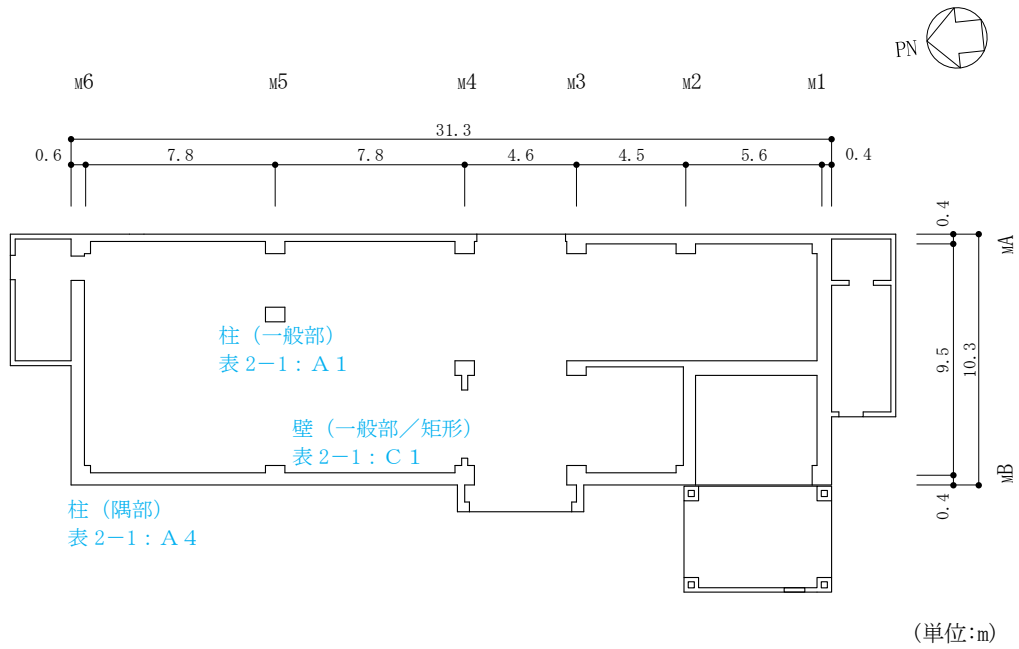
サイトバンカ建物（増築部）の概略平面図（EL 8.8m）
